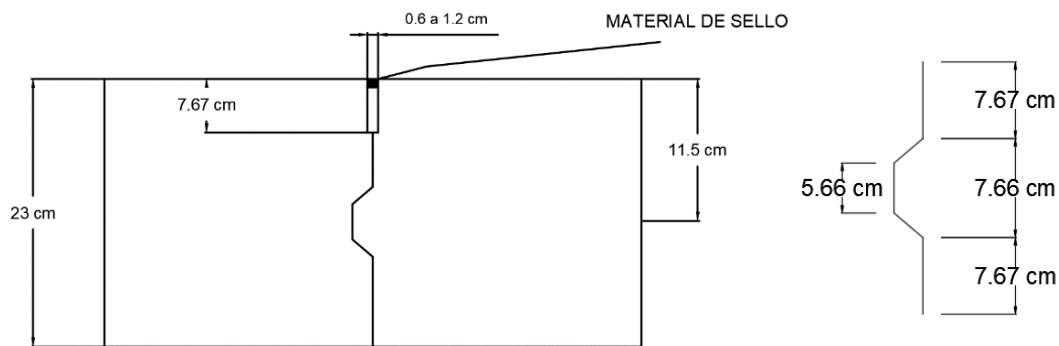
Junta Longitudinal Tipo A y dimensiones del machihembrado
